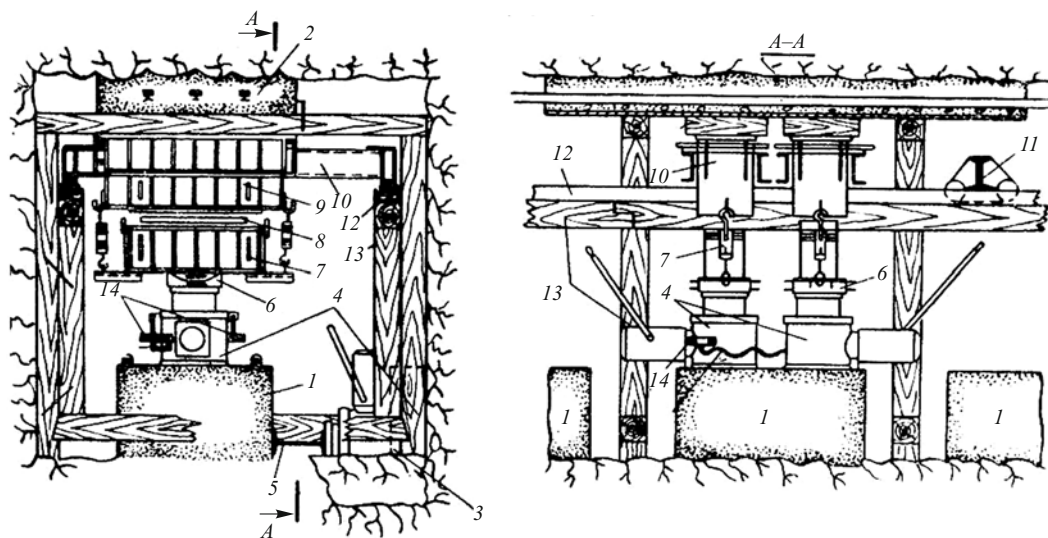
Опытная установка для исследований в штольне и штреках: 1 — бетонный штамп; 2, 3 — бетонные опорные плиты; 4 — домкраты; 5 — упорная балка; 6 — шаровая опора; 7 — 9 — опорные устройства; 10, 11 — кран-балки; 12, 13 — подкрановые пути; 14 — манометр
